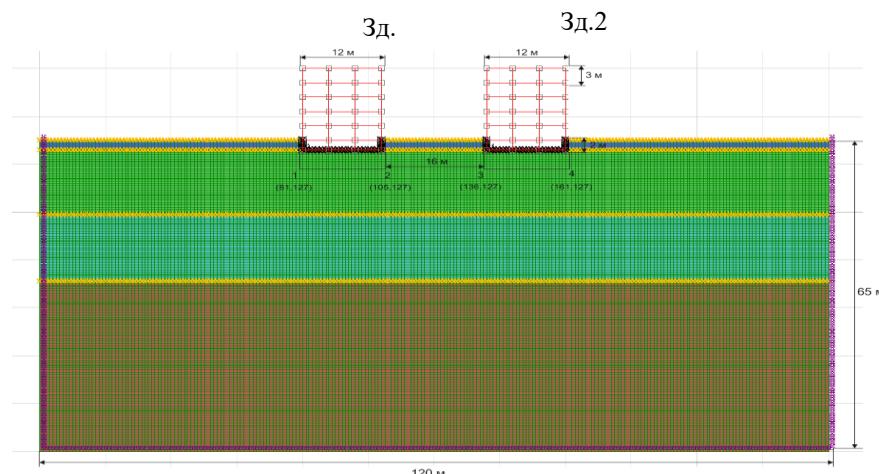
Расчетная схема к решению поставленной задачи: здание 1 – проектируемое; здание 2 – существующее
